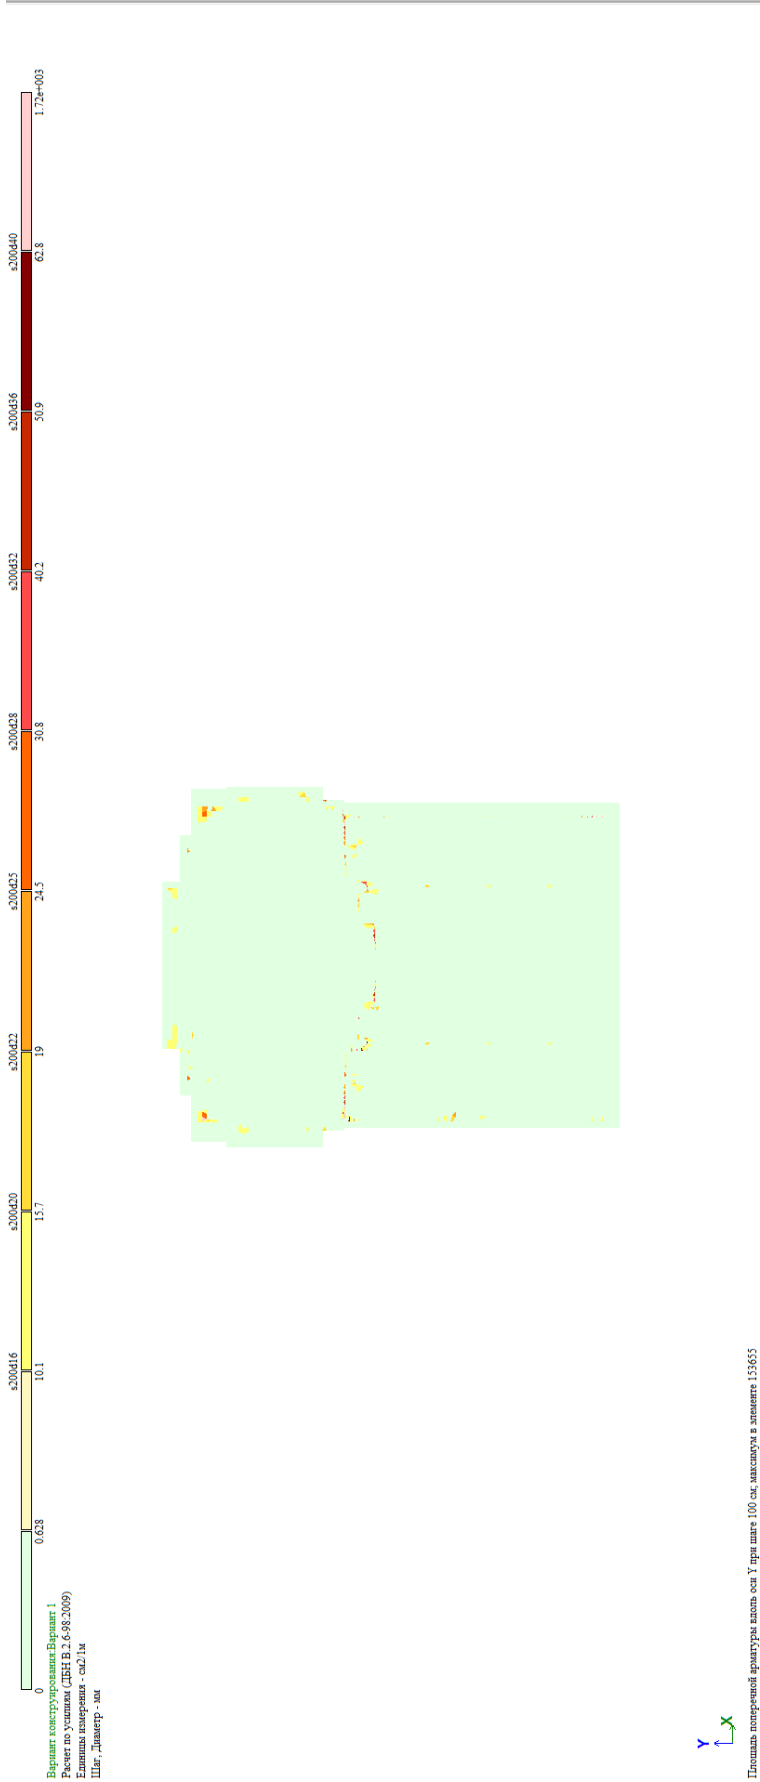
Схема розташування поперечної арматури по осі Y
